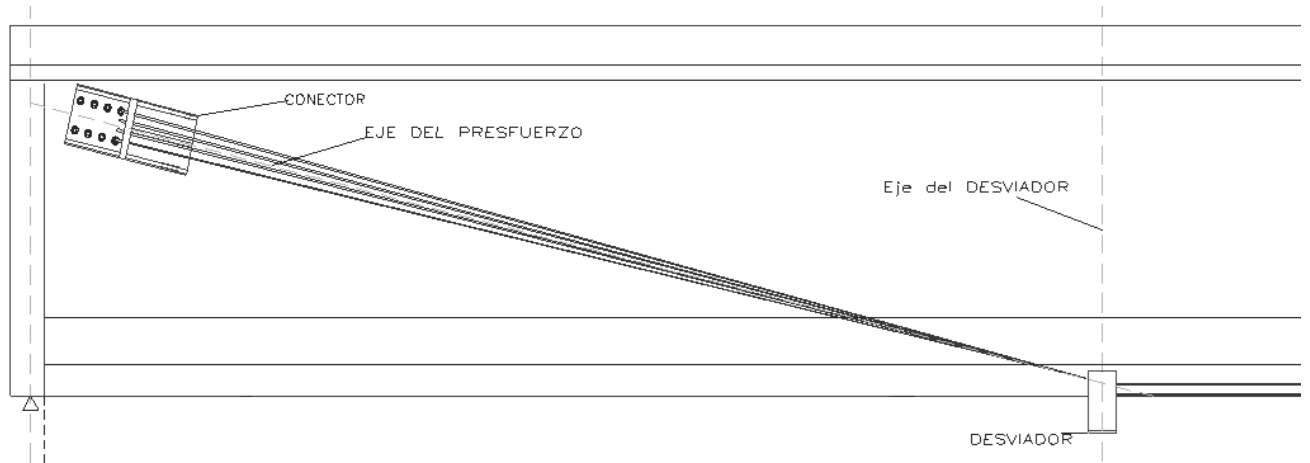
Corte longitudinal para colocación de preesfuerzo externo.
